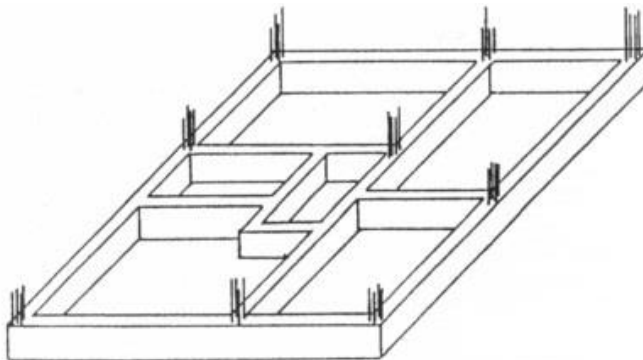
Viga Baldrame – Fonte: <http://www.fazerfacil.com.br/Construcao/alicerces.htm>; Acesso em out. 2016.
